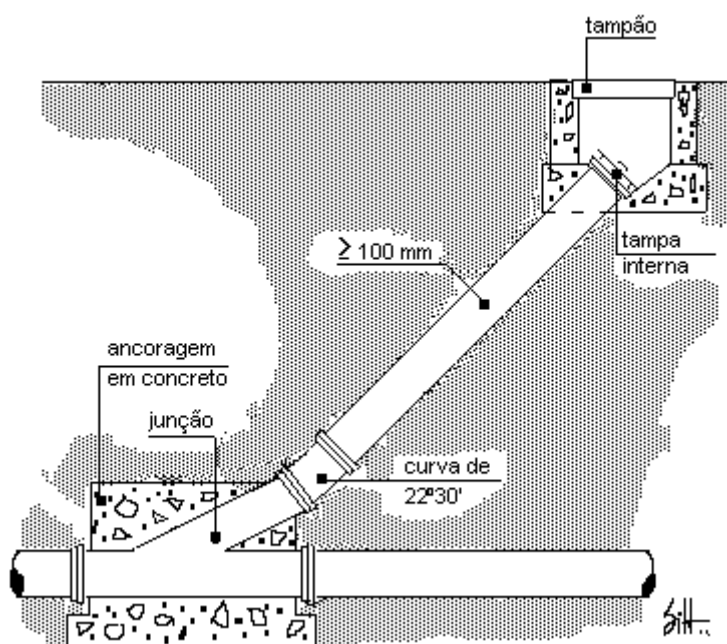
Corte esquemático de um TIL (Fernandes, 1997)
